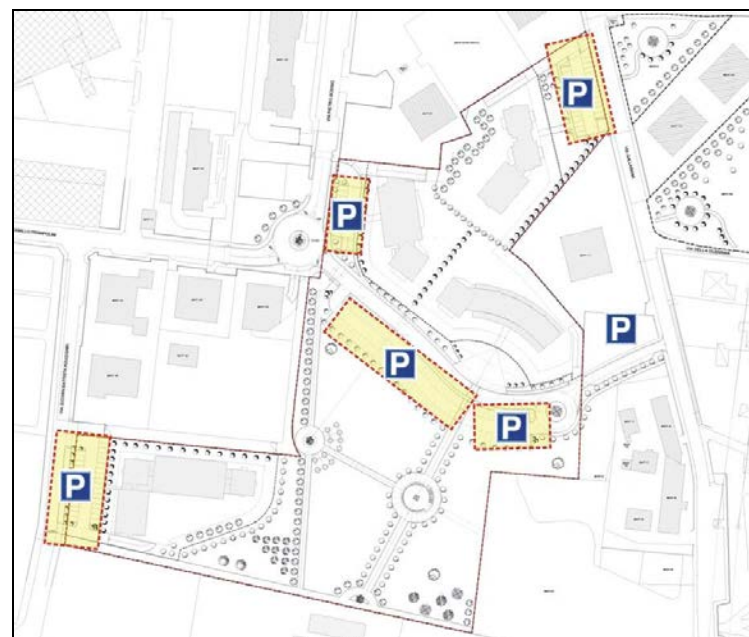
Planimetria di progetto – Aree parcheggio previste
